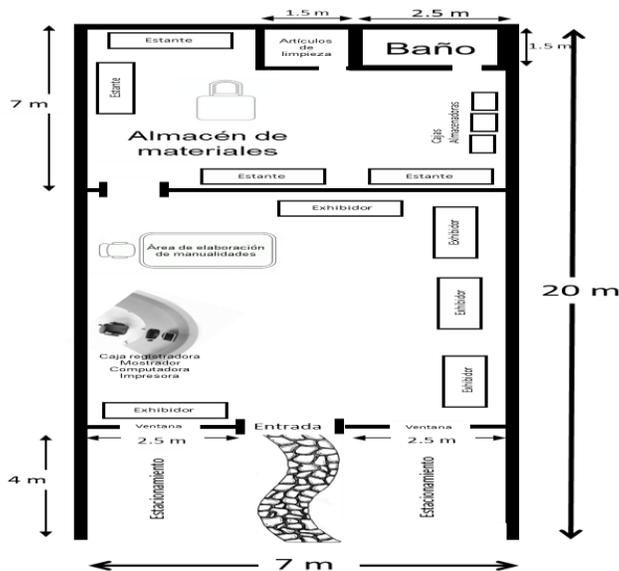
Distribución de la Planta (Elaboración Propia)
